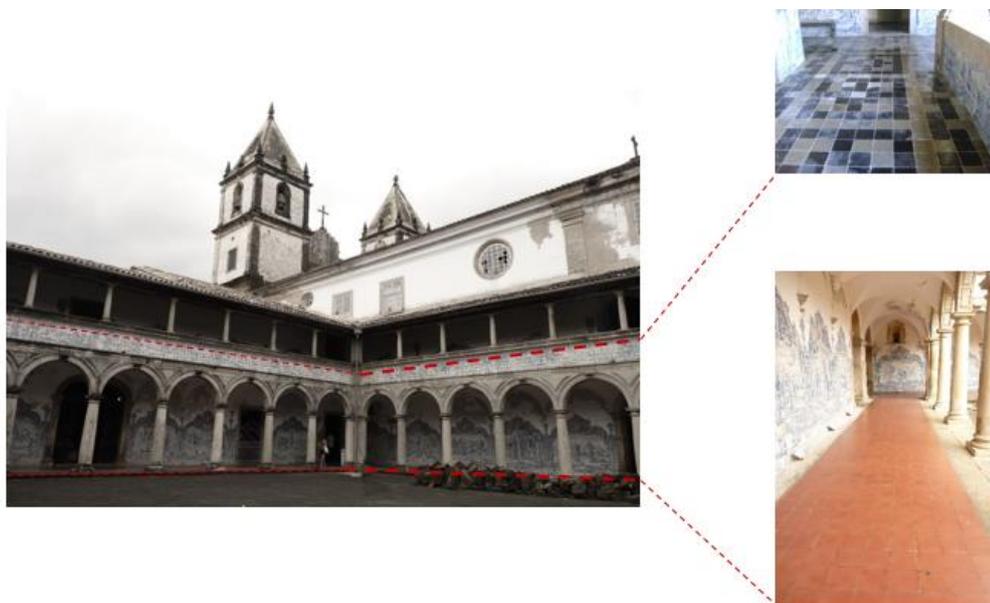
Vista da fachada da edificação; (b) Vista do *hall* de entrada da edificação.
